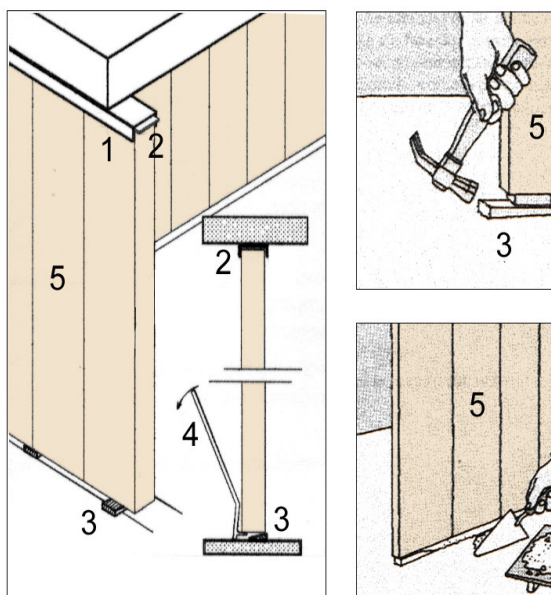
Montagem do painel de concreto celular autoclavado (1-perfil metálico; 2-placa de EPS; 3- cunha de madeira; 4-alavanca; 5- painel. SIPOREX,1999).
